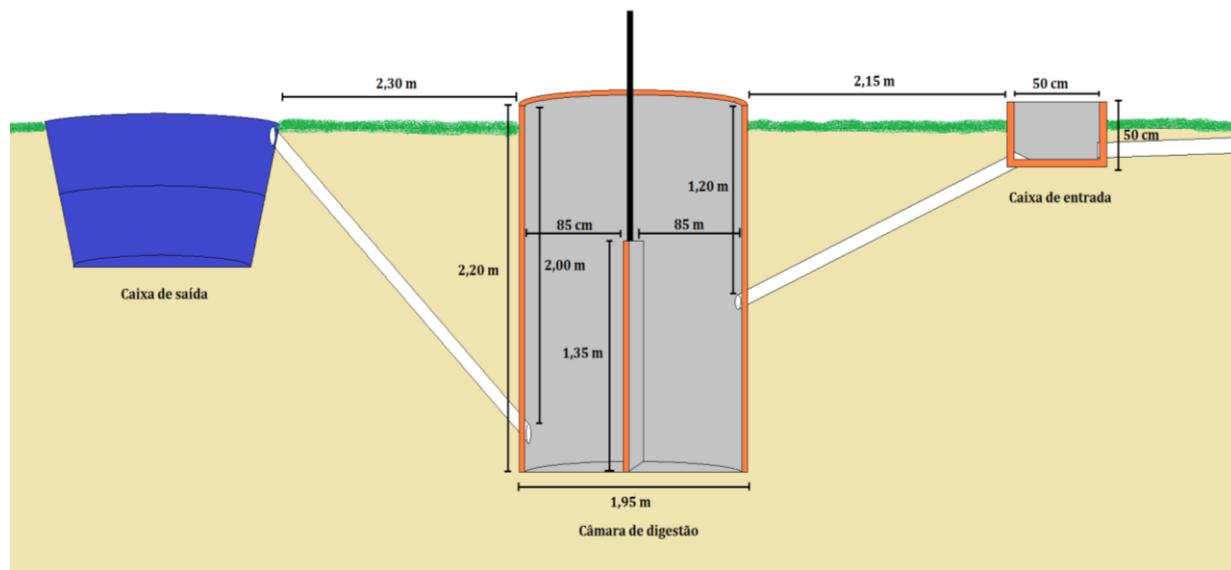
Ilustração em corte vertical da estrutura de alvenaria do biodigestor construído no IFRN – campus Apodi
